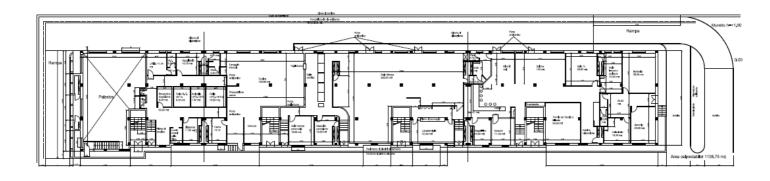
Stralcio del rilievo architettonico reperito Padiglione n.16. – Pianta piano rialzato
